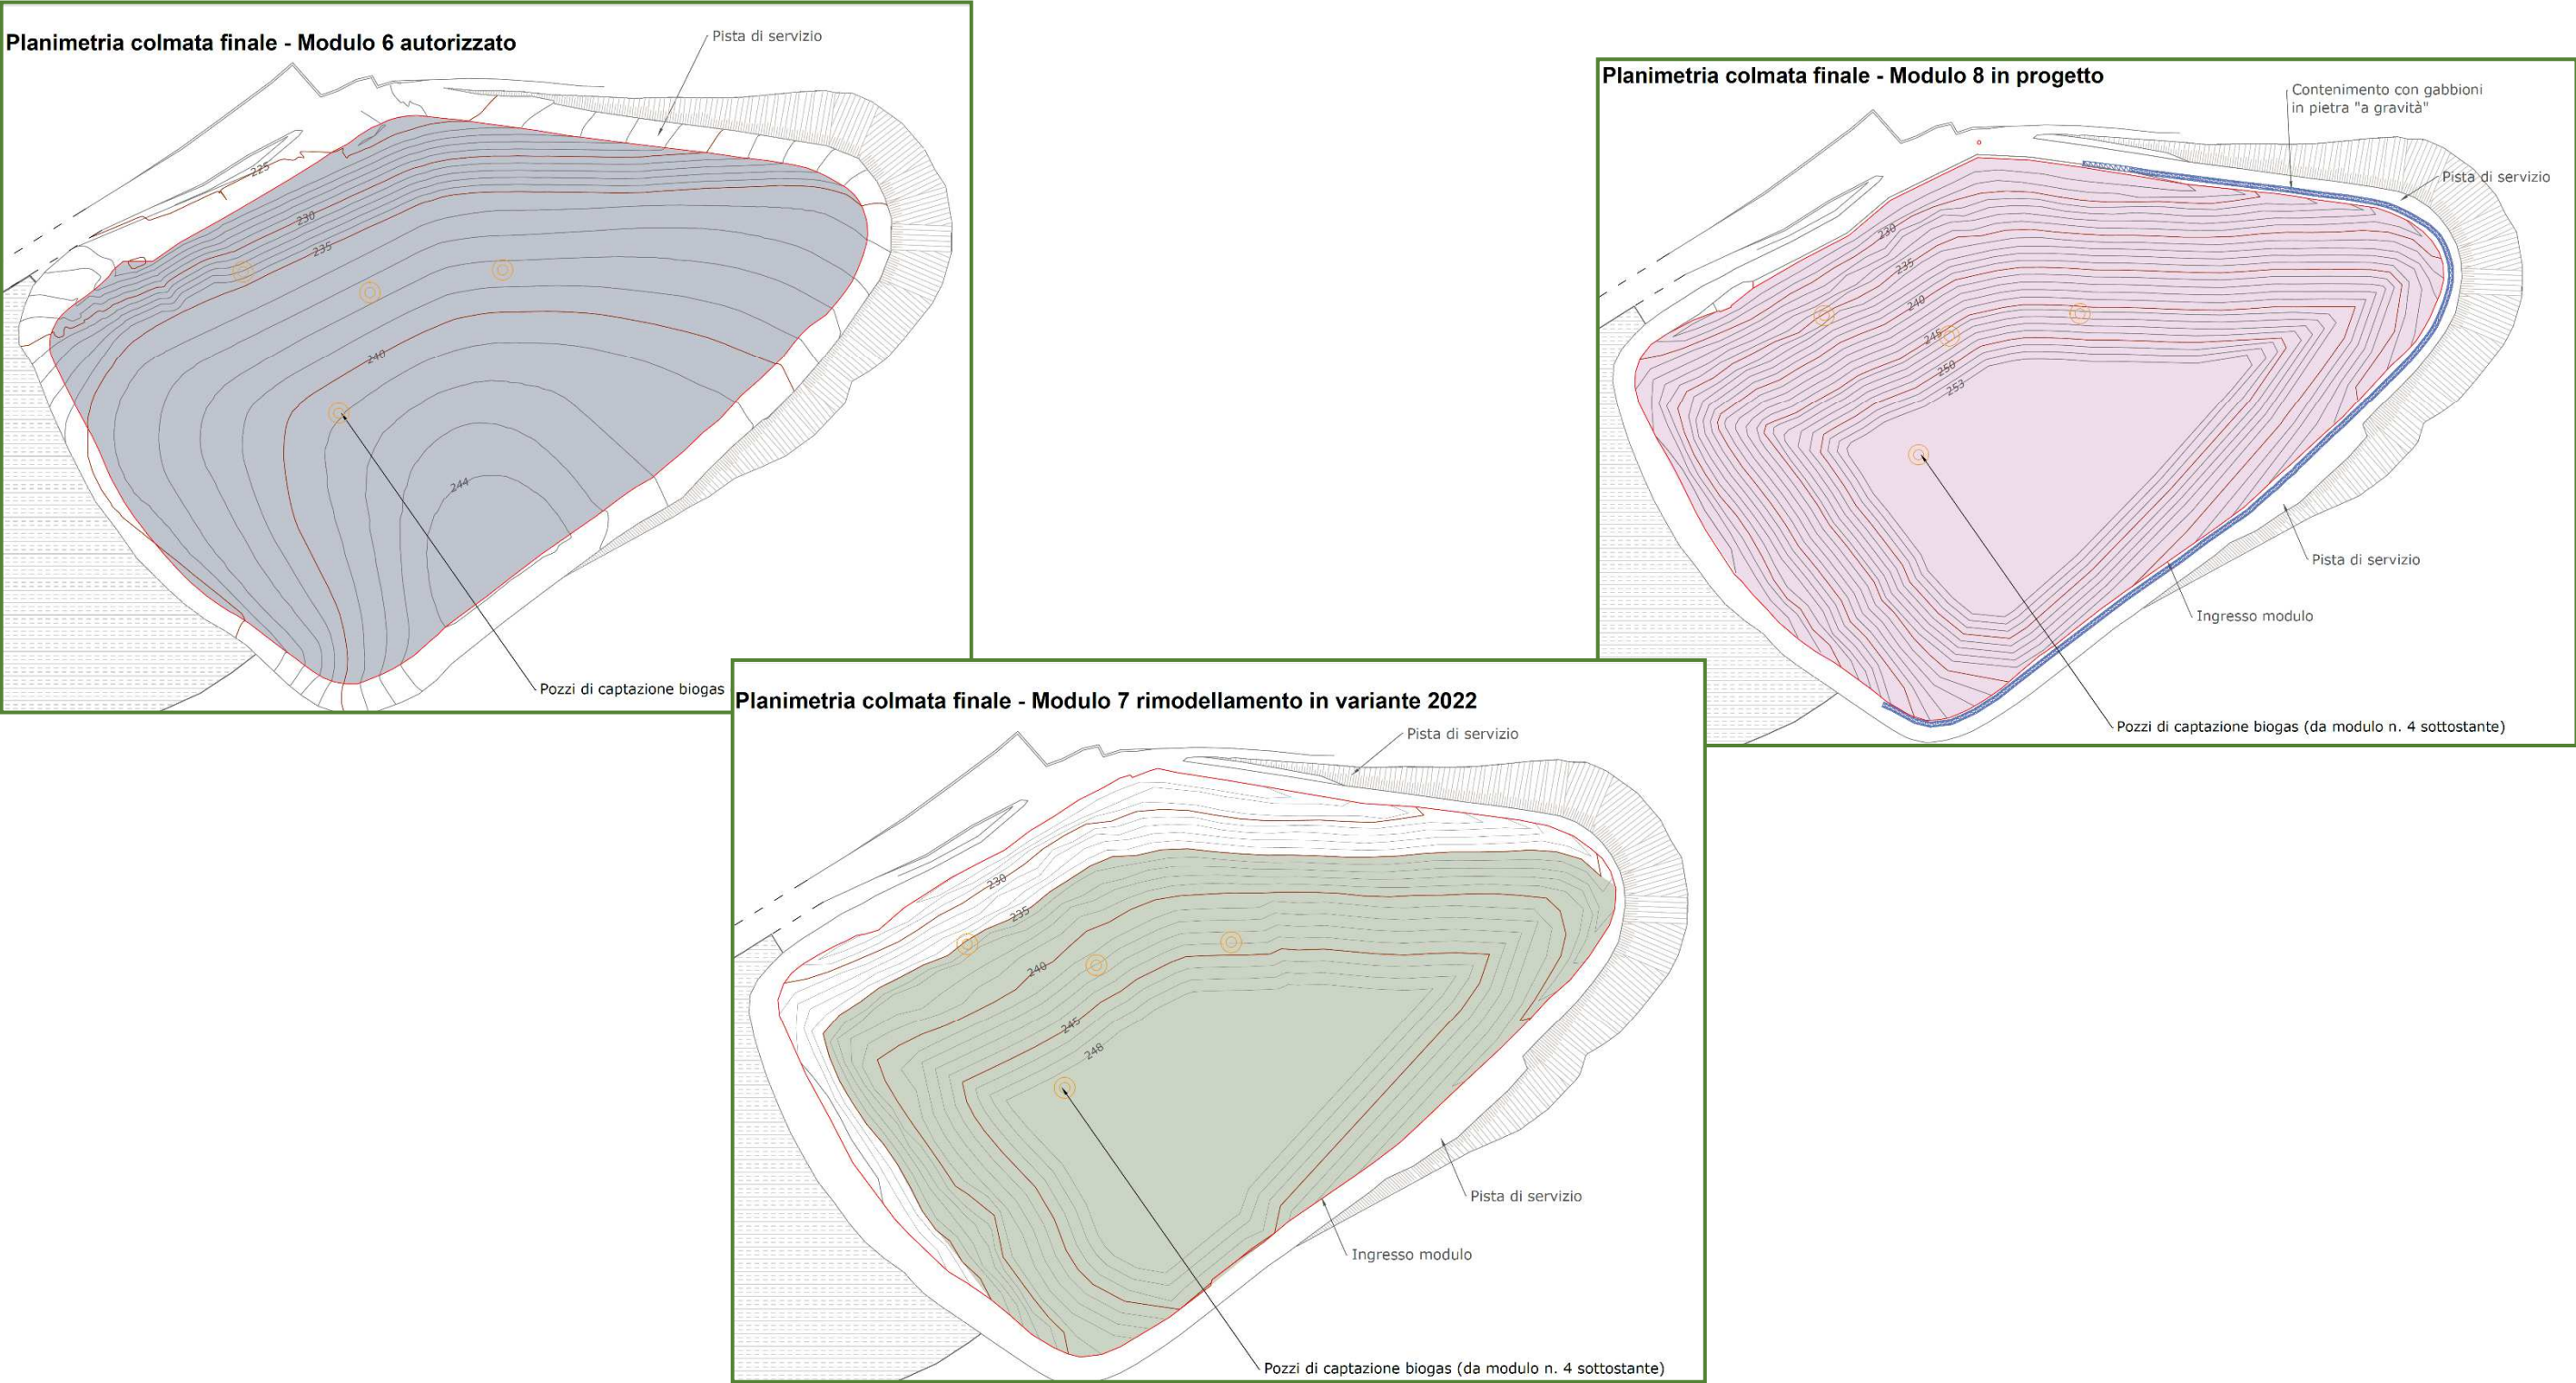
/II: Planimetrie stato autorizzato e di progetto
